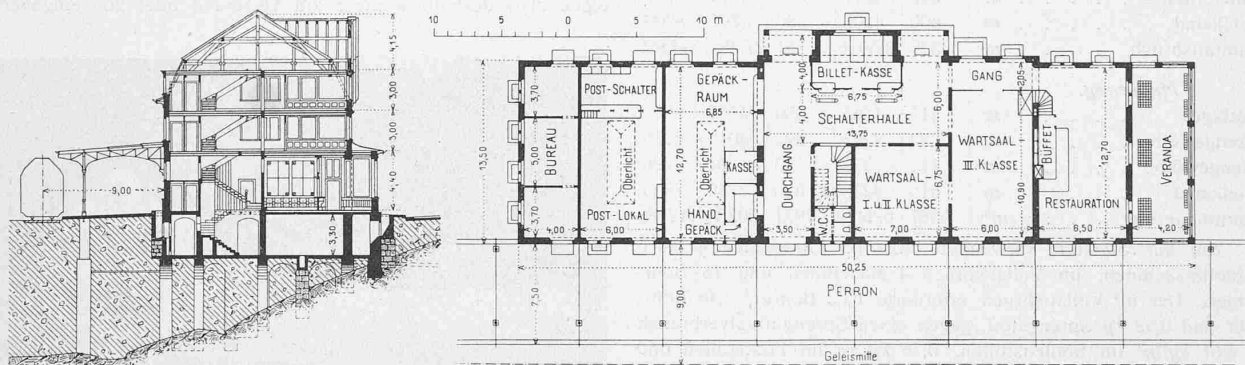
Schnitt in Gebäudemitte und Erdgeschoss-Grundriss des Aufnahmegebäudes Herisau — Masstab 1:500.
